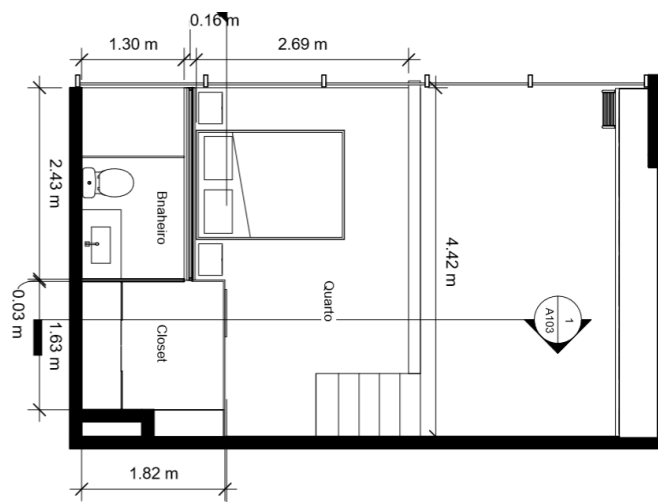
Planta baixa do mezanino do *loft* duplex Metanias Seman Hallack.
